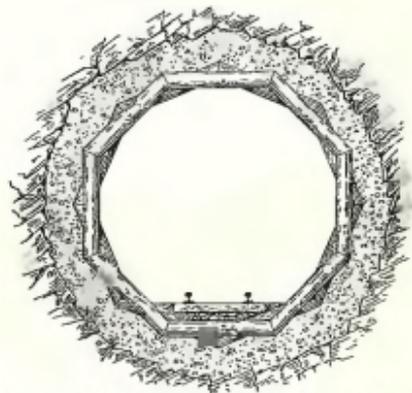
Betonansbau in Verbindung mit Polygonzimmerung.
